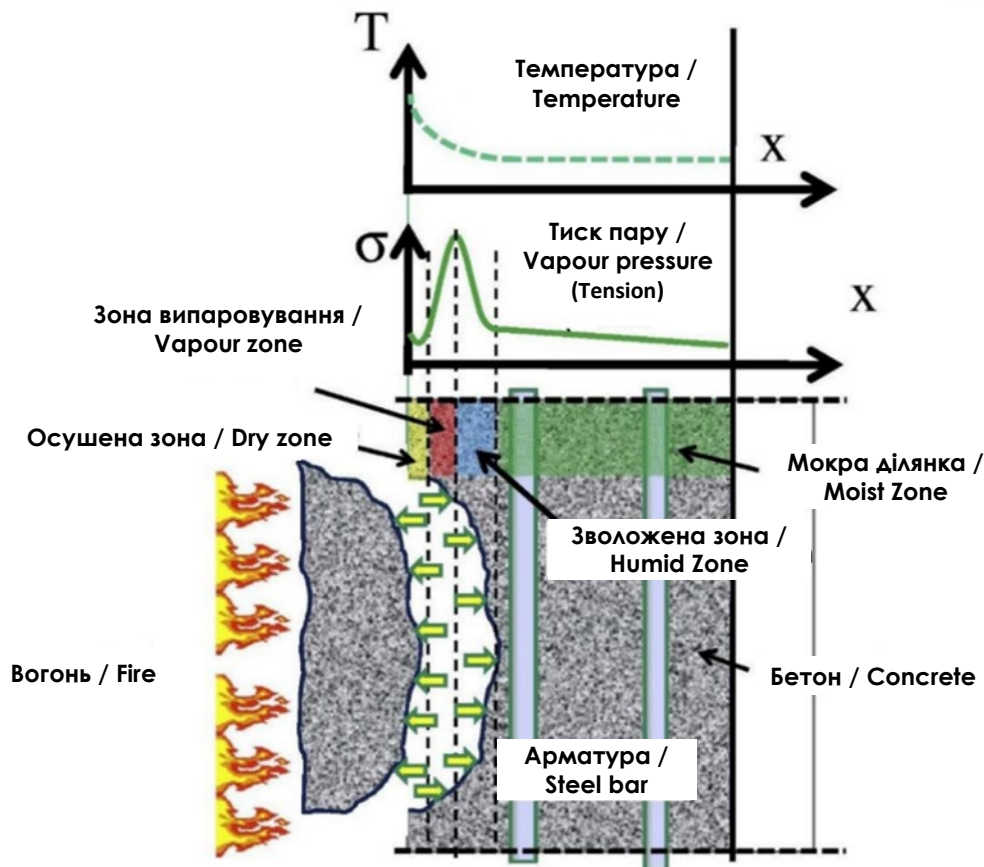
Утворення відколювання захисного шару залізобетону під дією вогню / Spalling of the protective layer of reinforced concrete under the influence of fire
